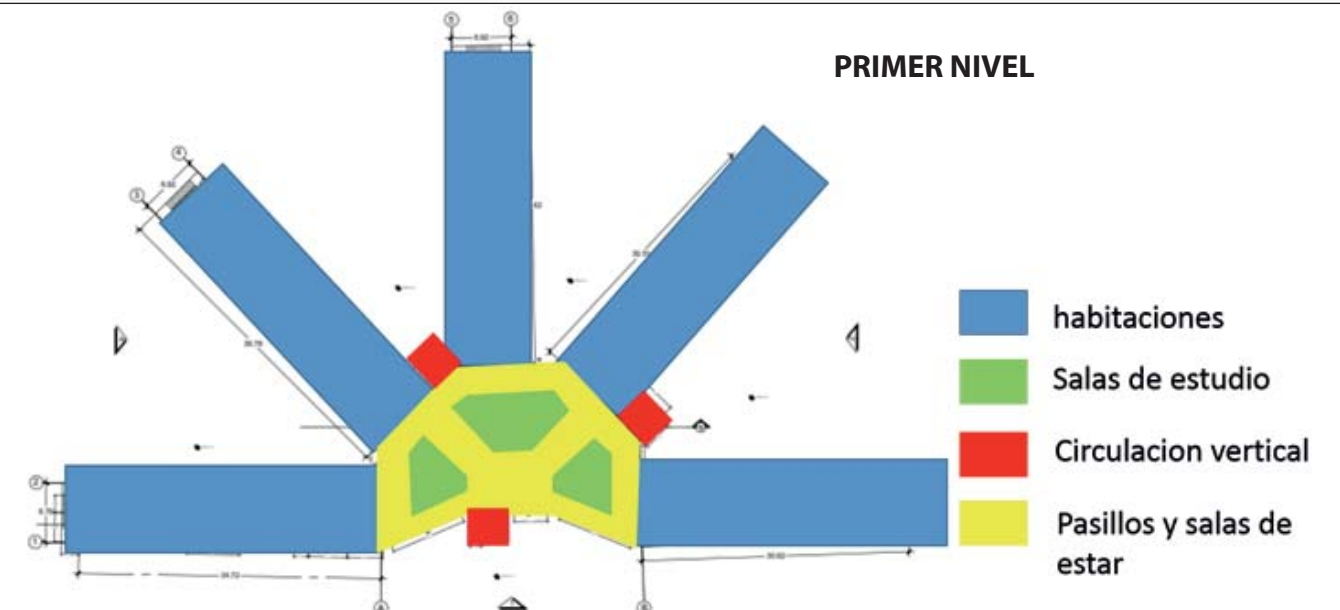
Distribución de la planta arquitectónica del primer nivel
